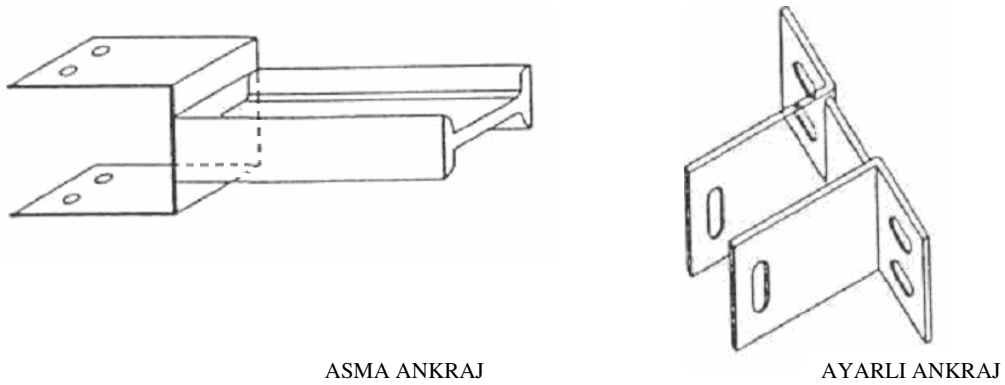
Tipik Cephe Tespit Plan Detayı [Uzak, 1998]
